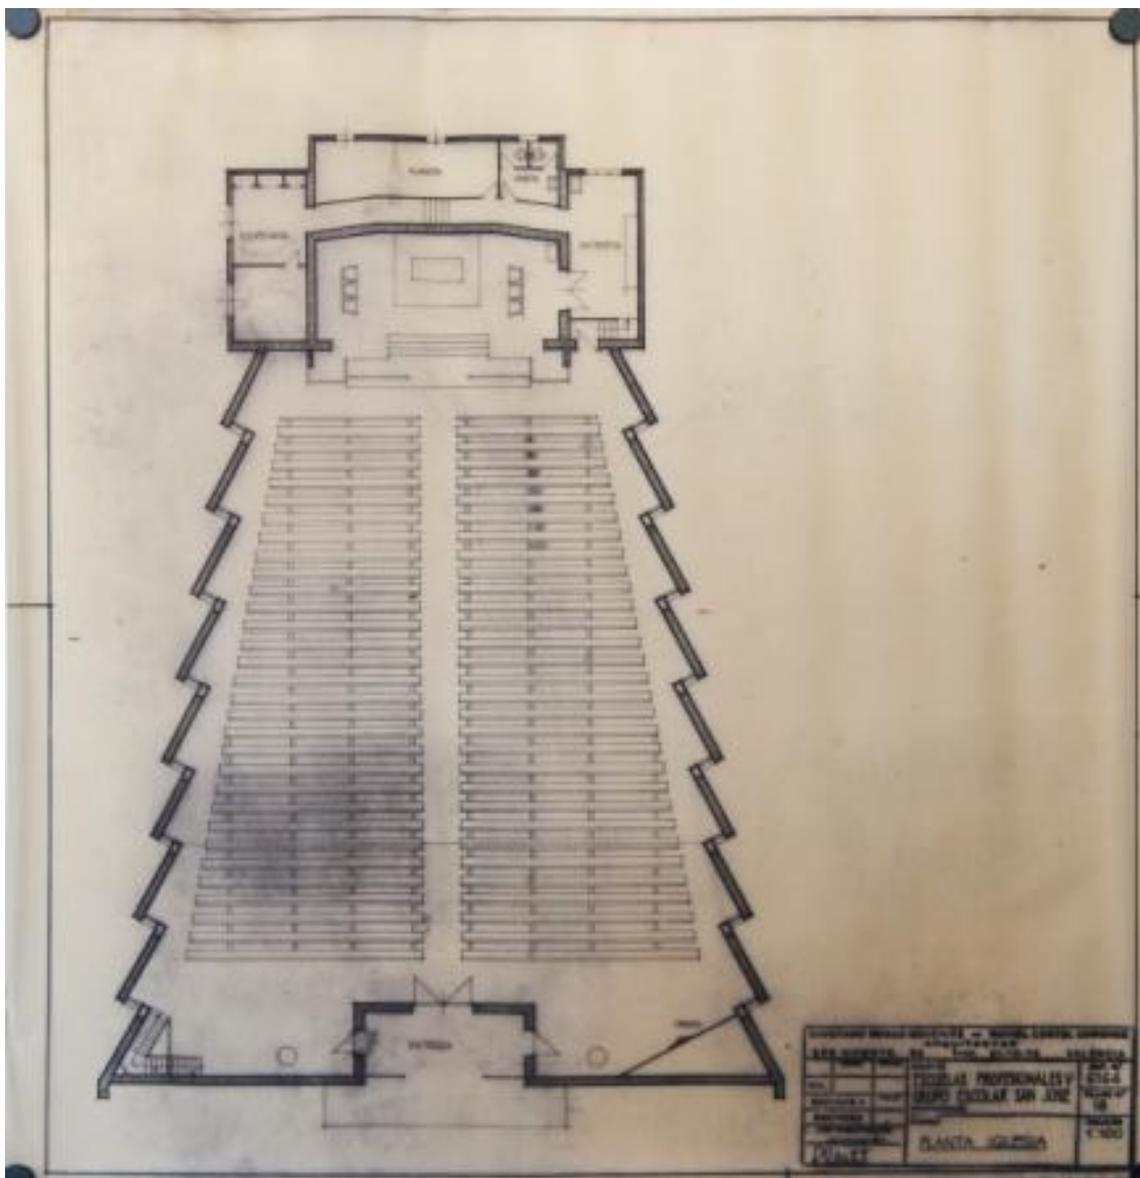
Planta primera propuesta iglesia. *Archivo Escuelas San José.
